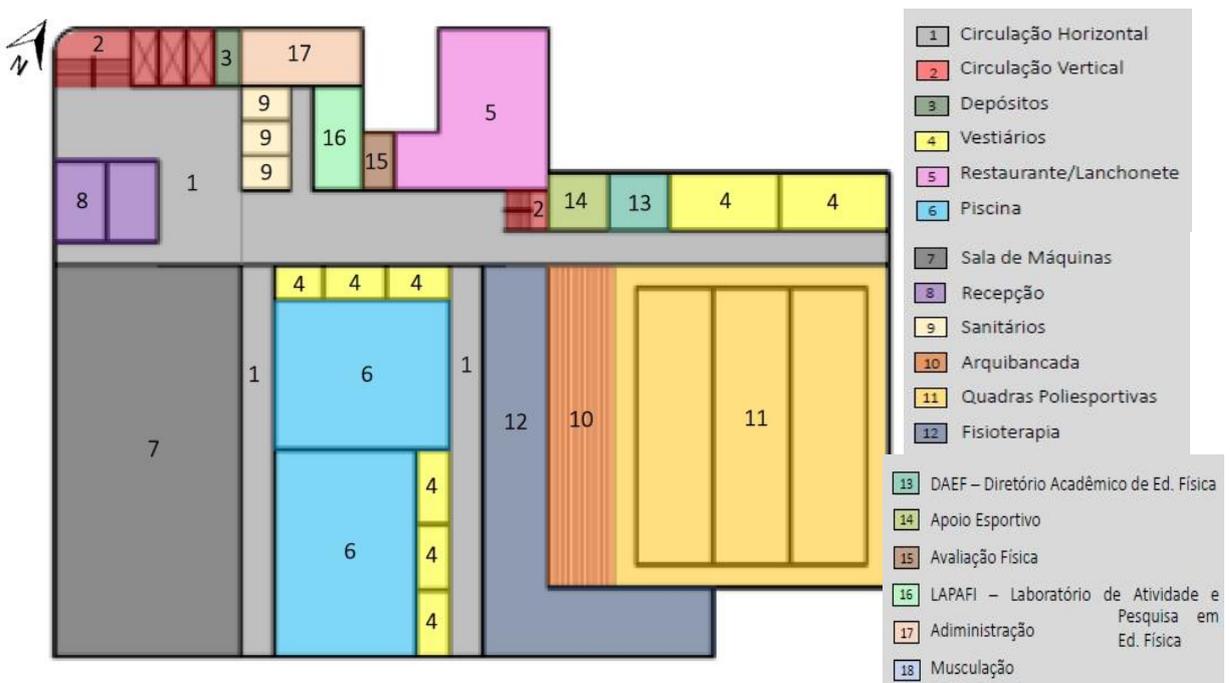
Planta Baixa do Térreo do parque PUCRS
